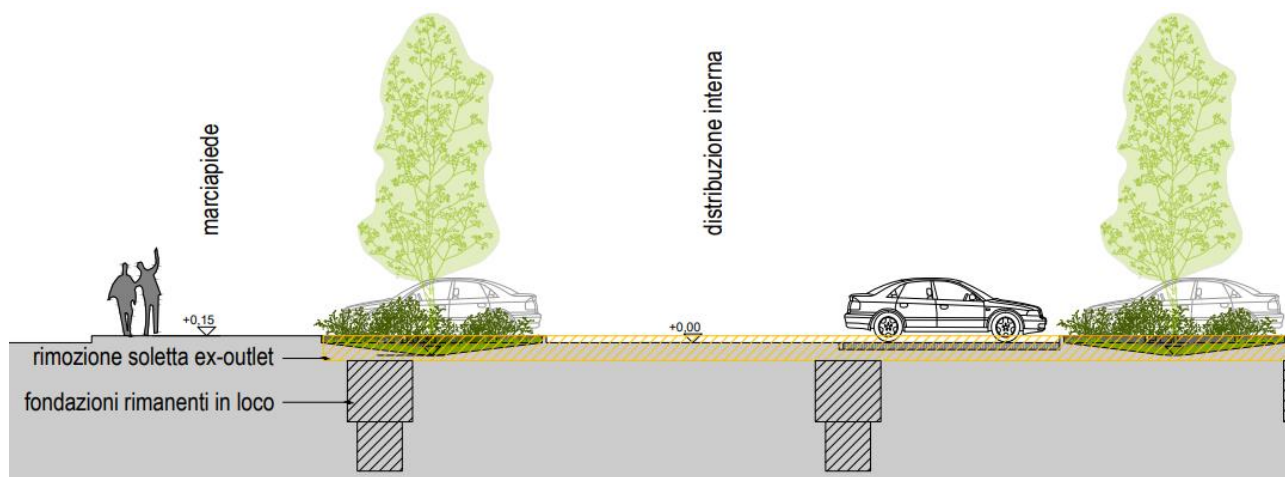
Dettaglio progetto del verde - Area ex Outlet
